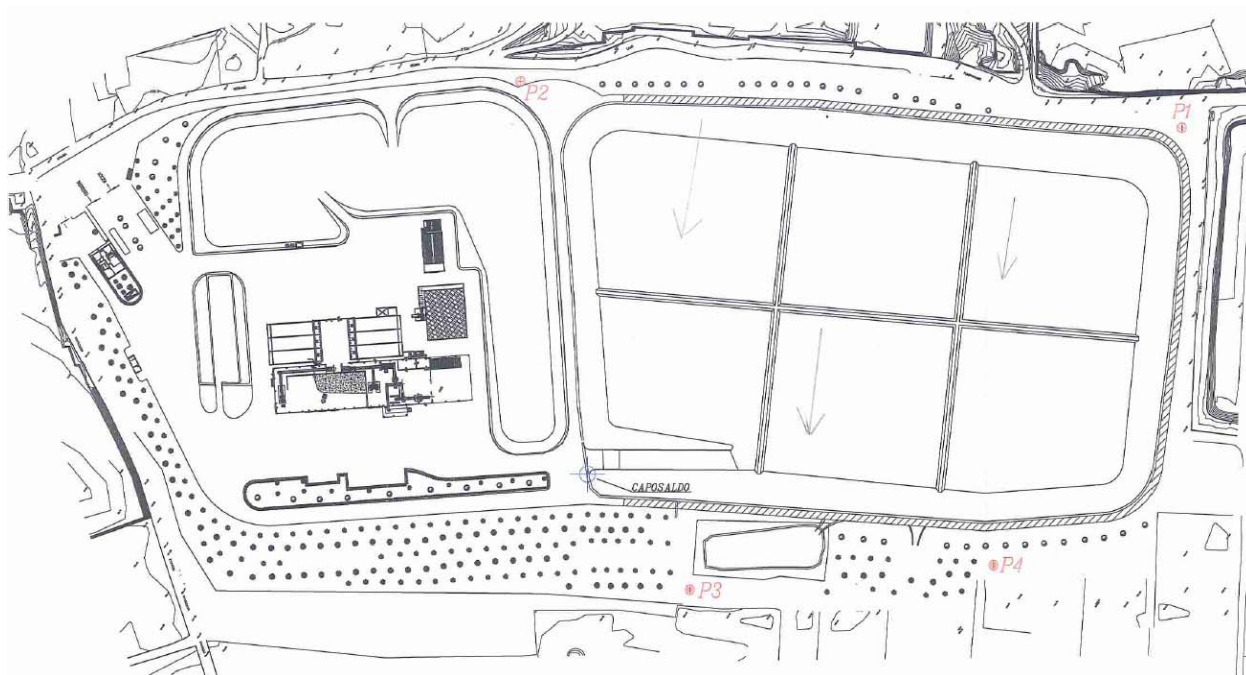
Planimetria pozzi discarica Progetto Ambiente Bacino Lecce Tre Surl
